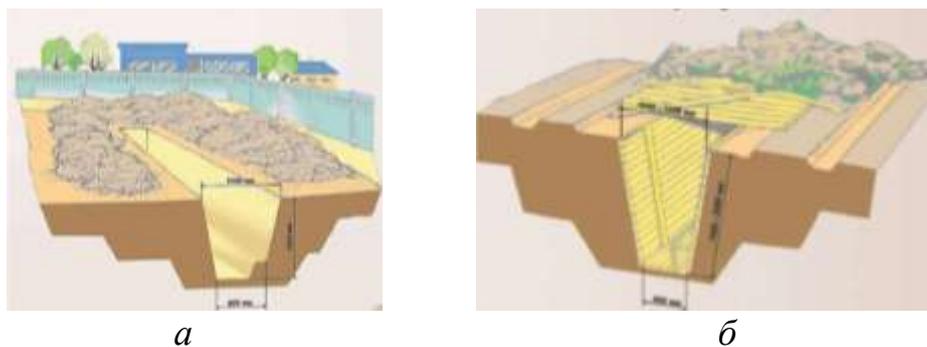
Щель для укрытия: а – открытая; б – перекрытая
